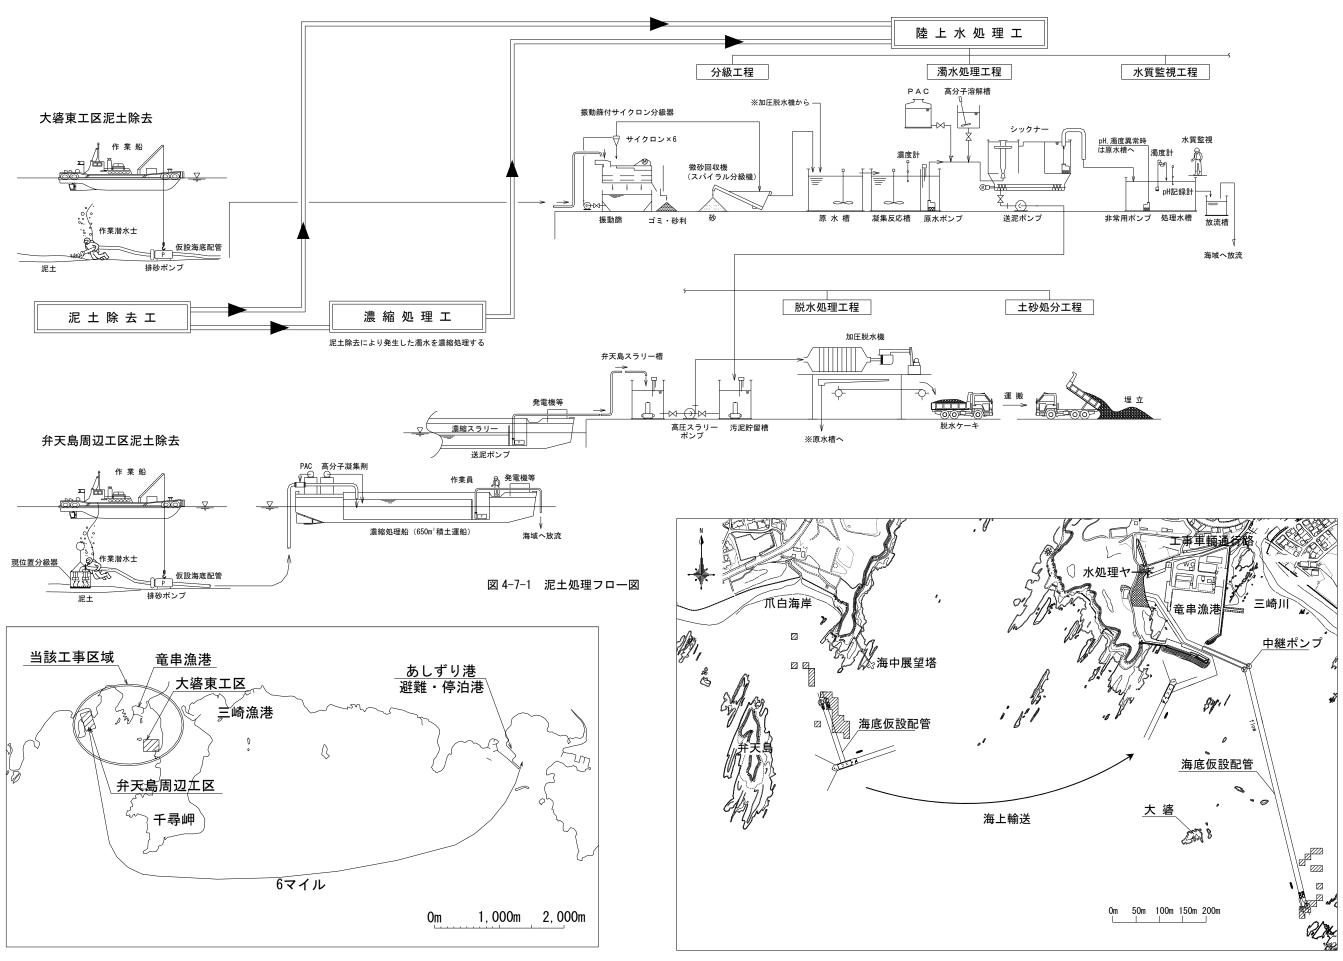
全体位置図 図 4-7-3 全体平面図
